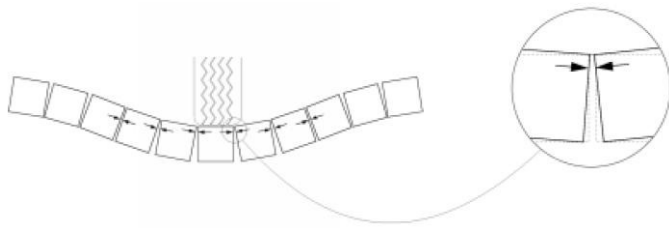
Schéma typique d'une chaussée revêtue de pavés de béton
